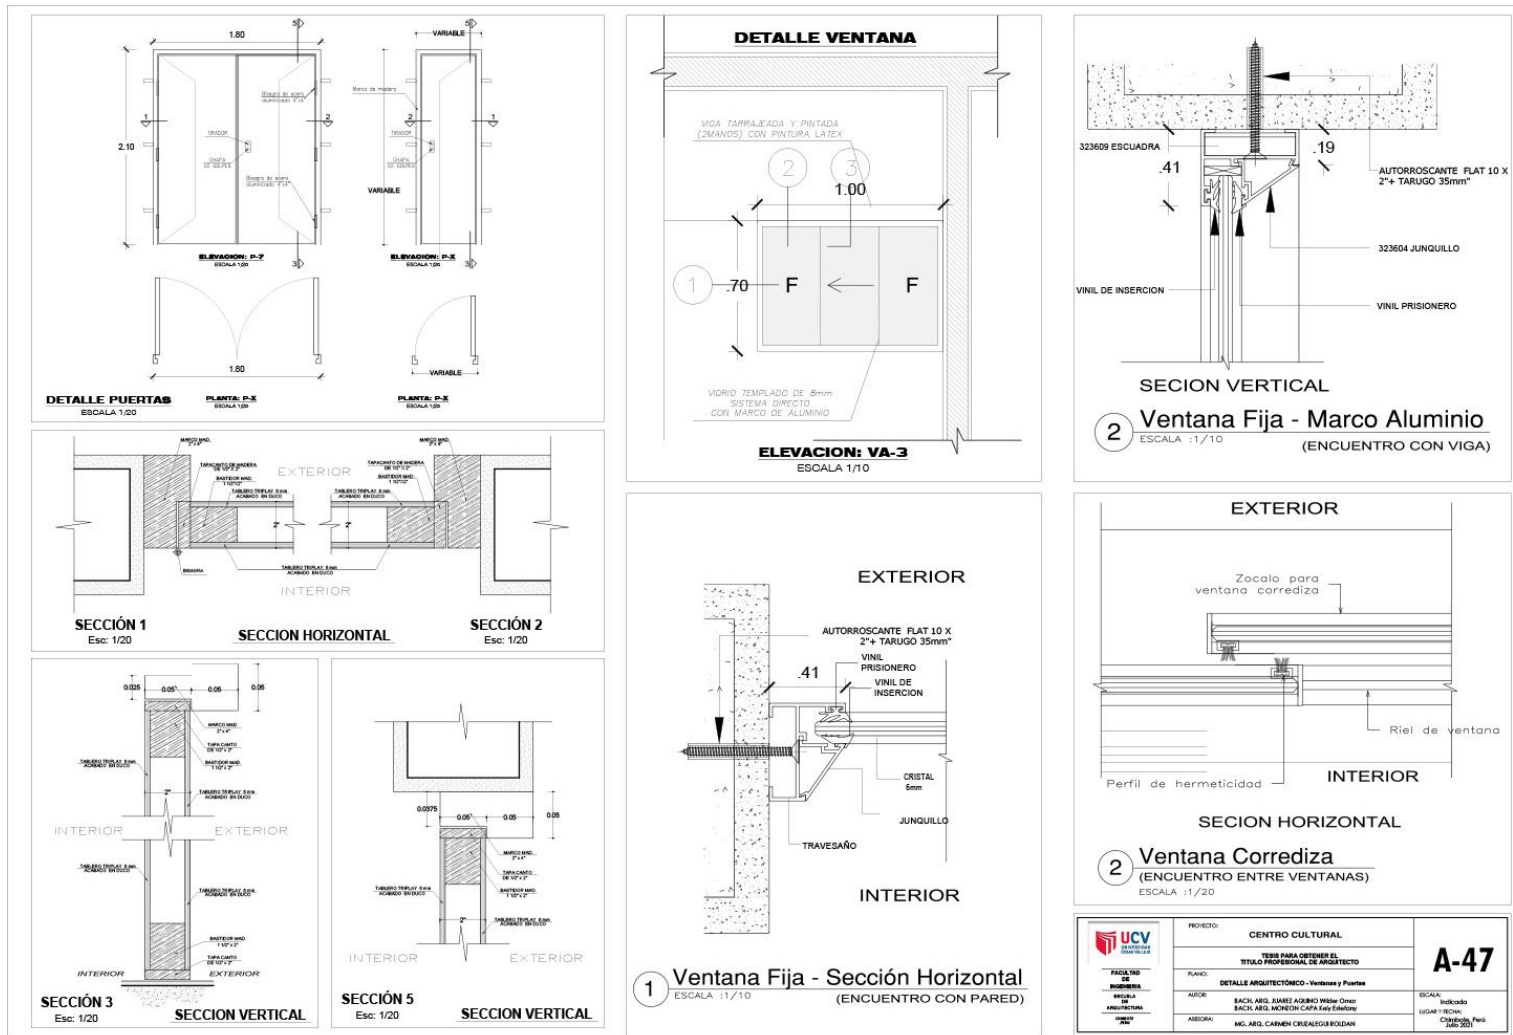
Detalle Arquitectónico – Ventanas y Puertas
